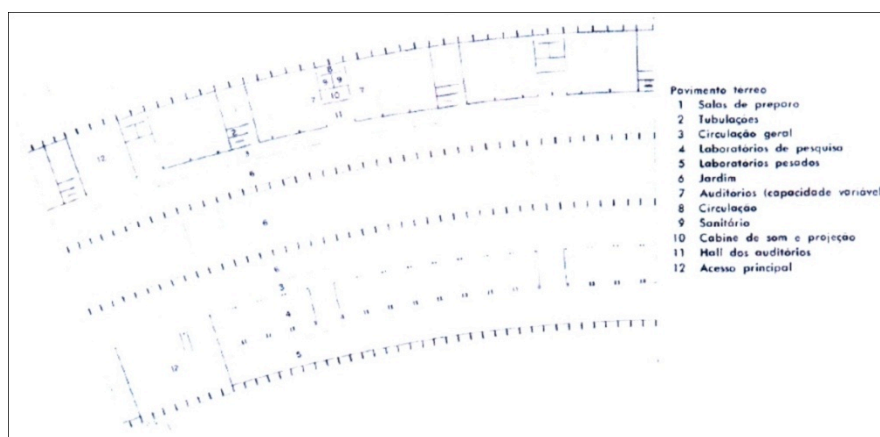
Planta Baixa pavimento térreo ICC. Fonte: Acrópole, 1970.
